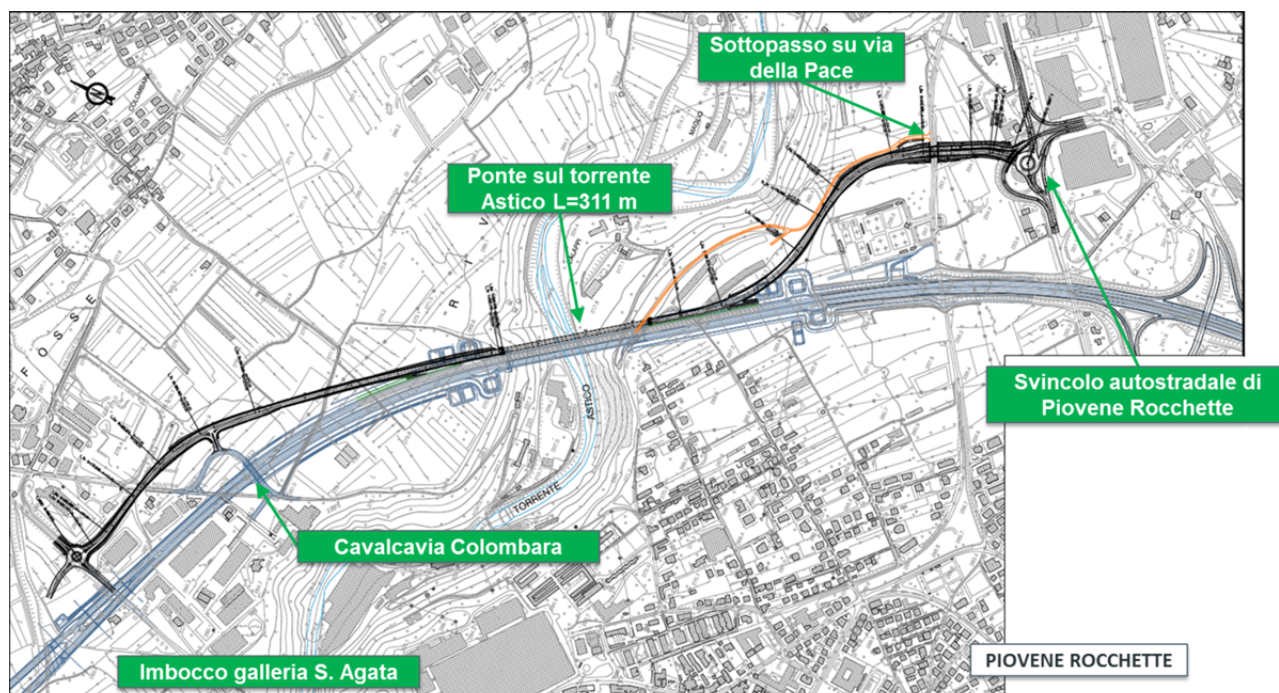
Planimetria della bretella tra Piovene Rocchette e Cogollo del Cengio
